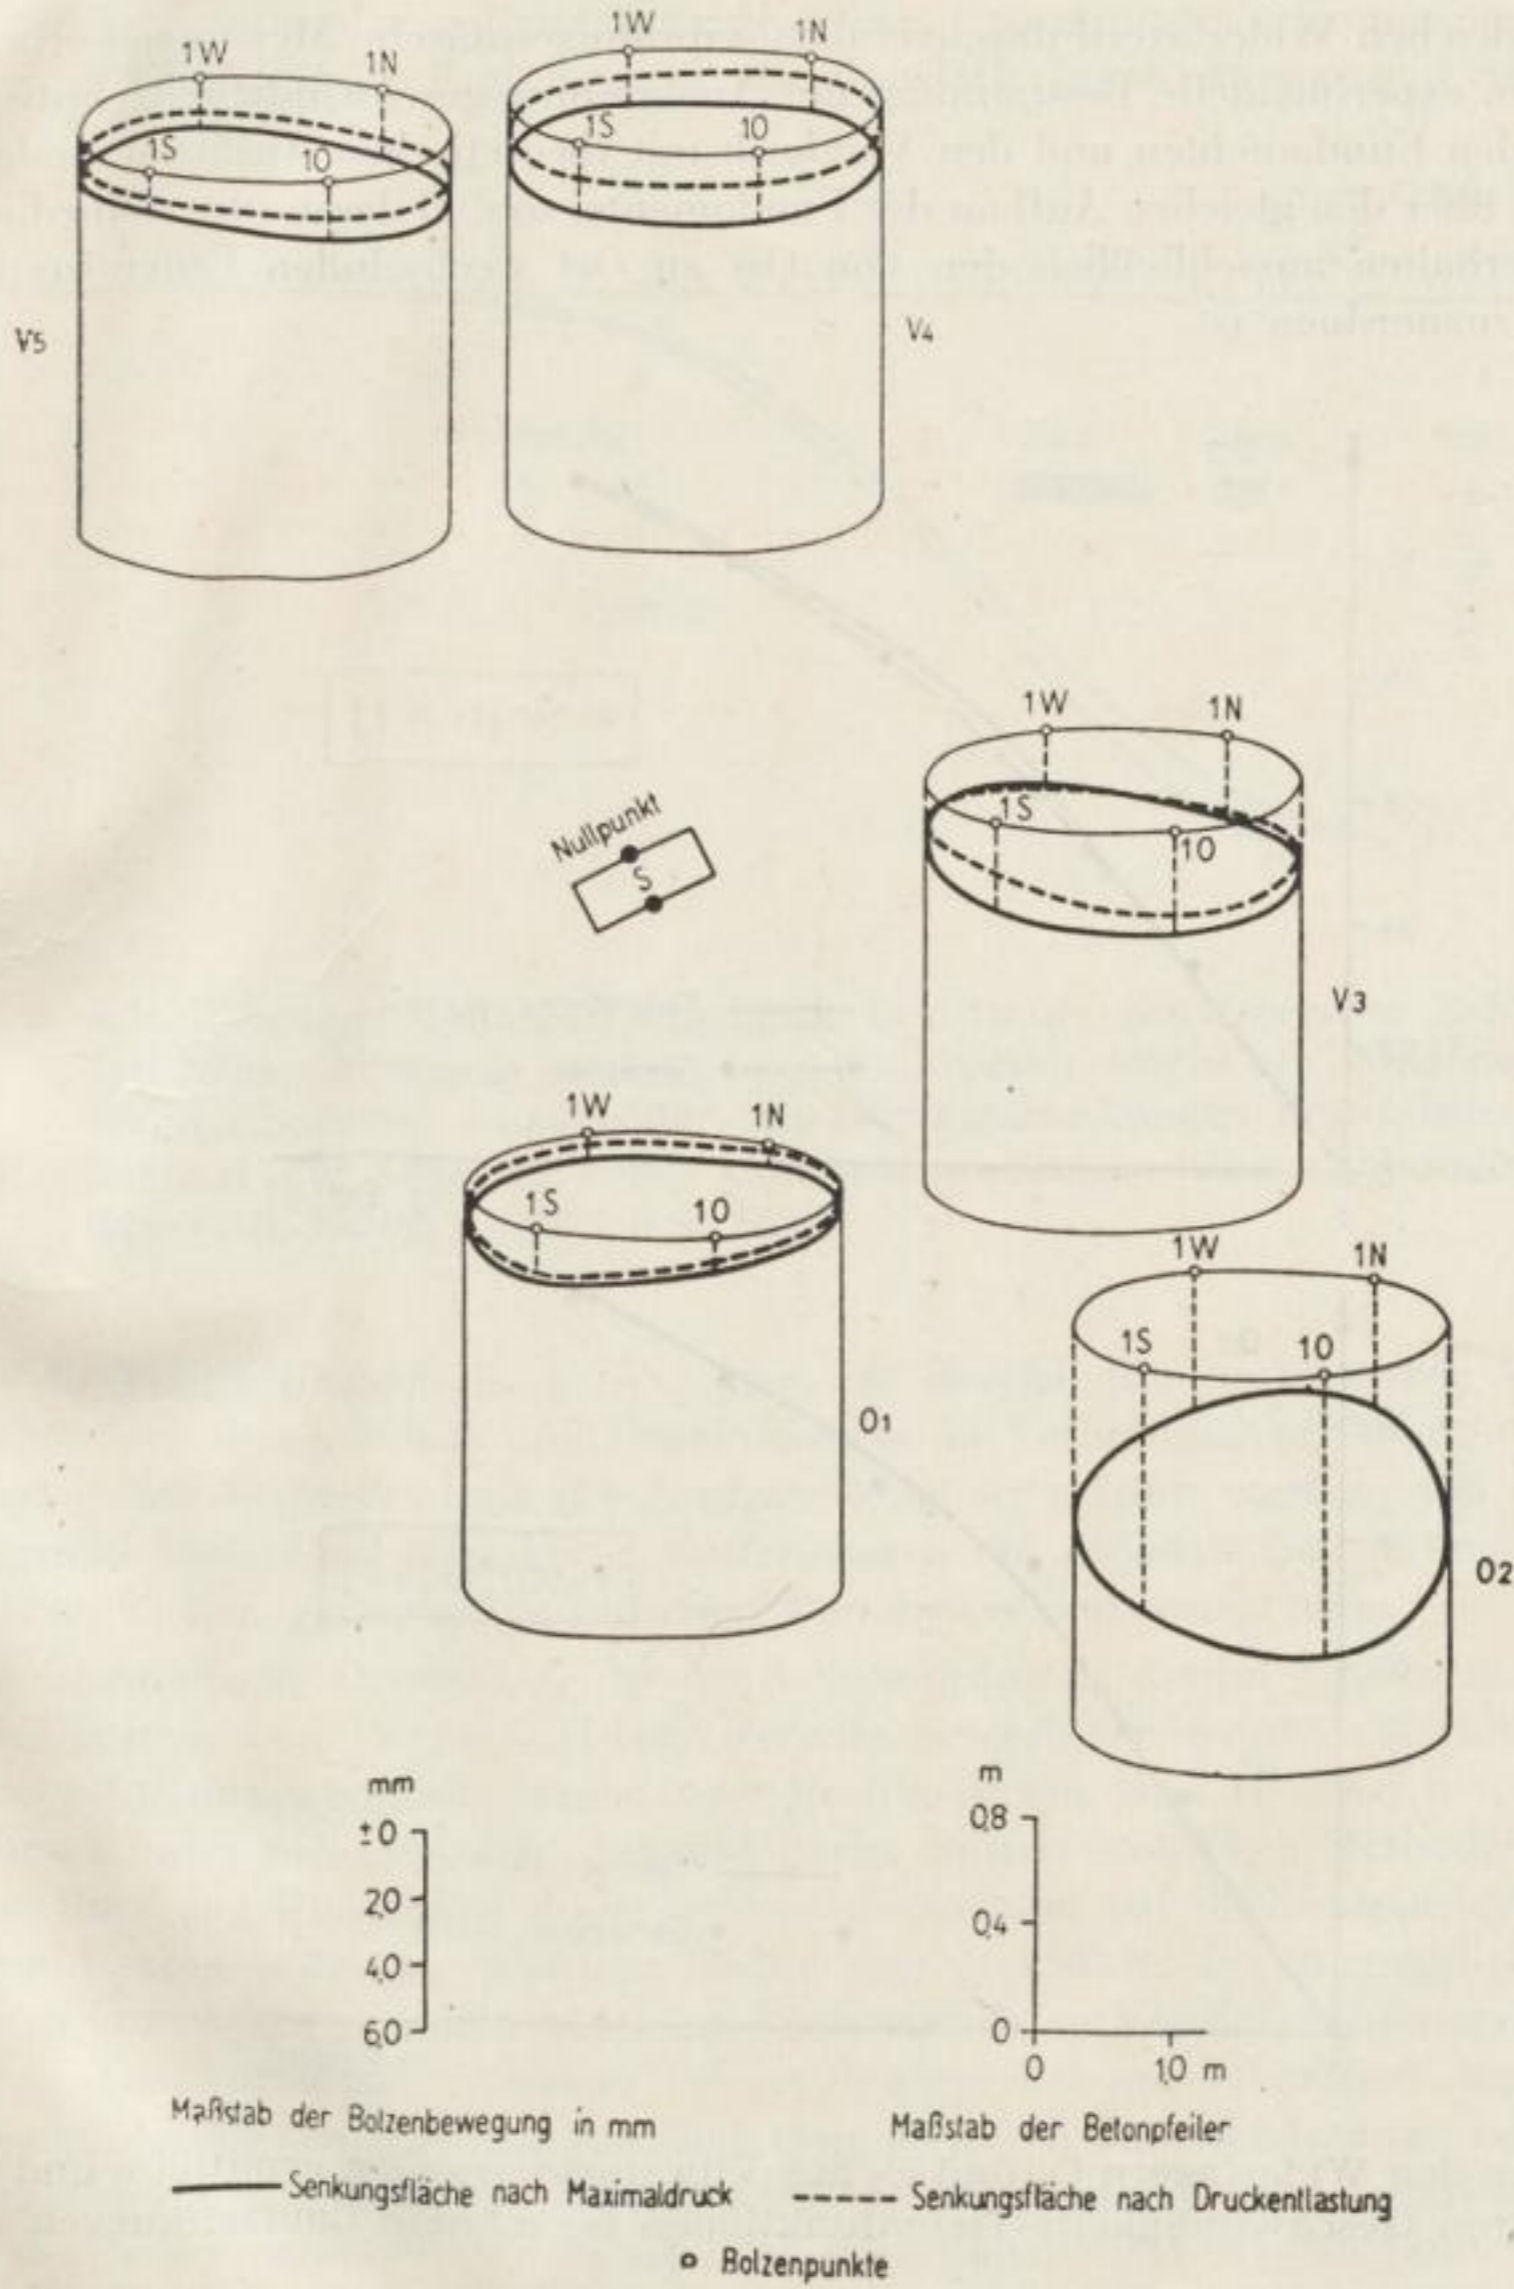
Raumdarstellung der abgedrückten Widerlager einschließlich der Senkungsflächen nach aufgebrachtem Maximaldruck und nach Druckentlastung
